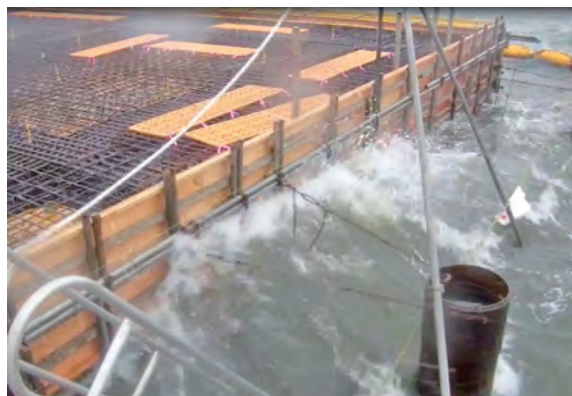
現場打ち RC 栈橋上部工施工状況(例)
